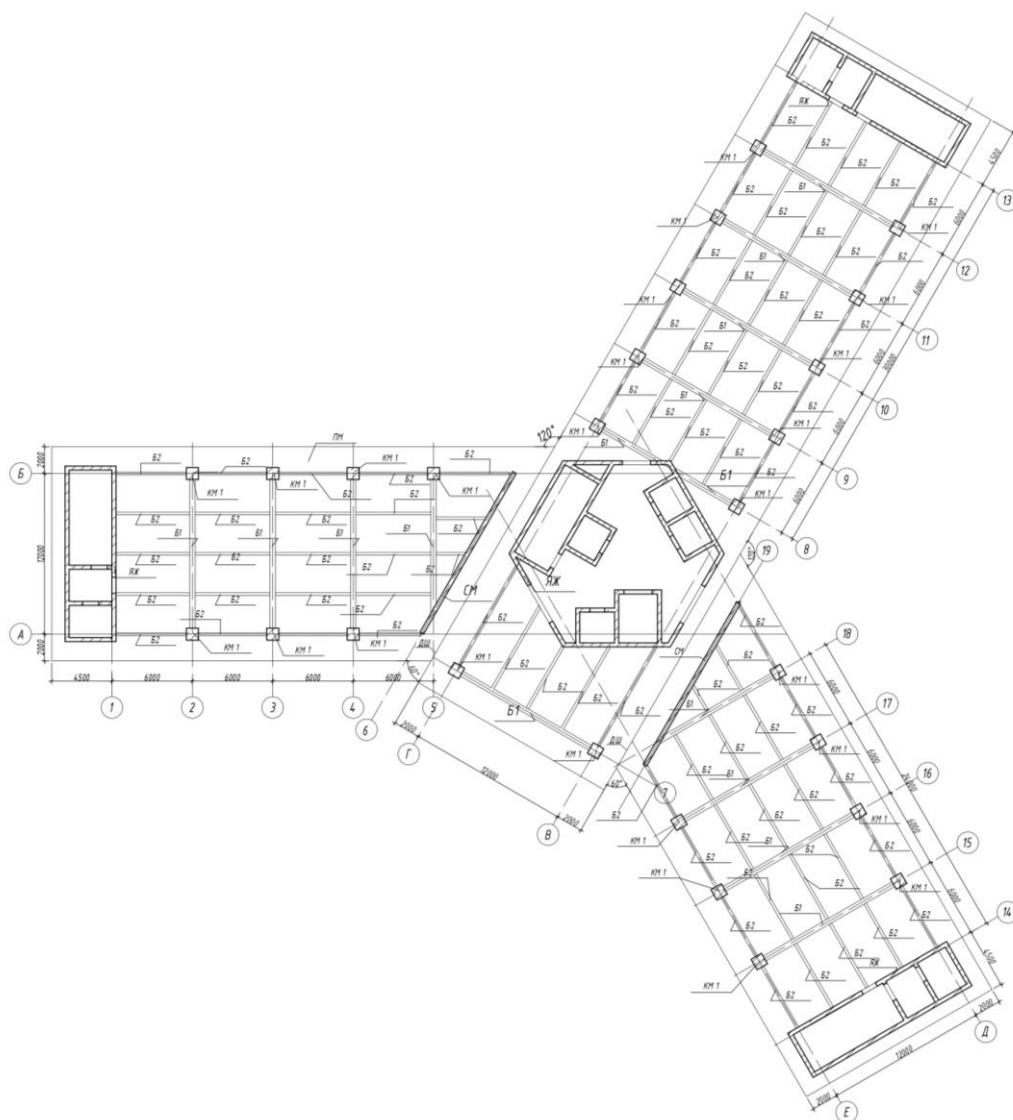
Схема расположения несущих элементов железобетонного каркаса
